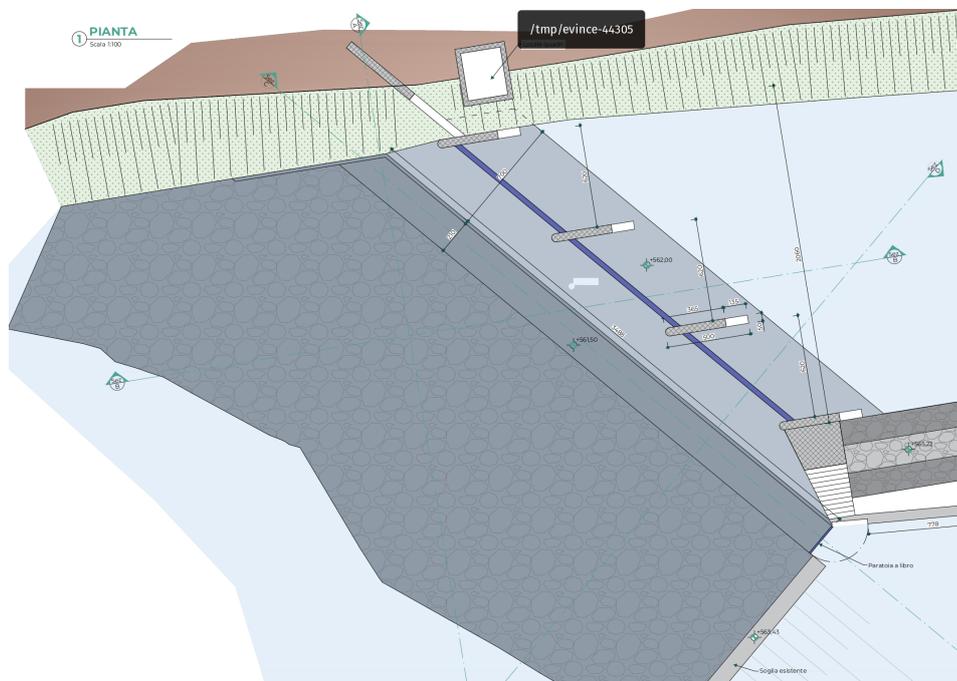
Vista in pianta del sistema di paratoie di sicurezza all'imbocco di monte del canale Paravera.
